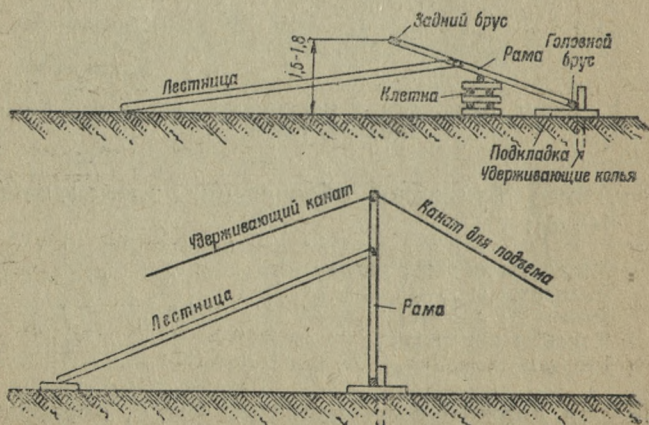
Схема сборки и подъема нижней рамы с лестницей
